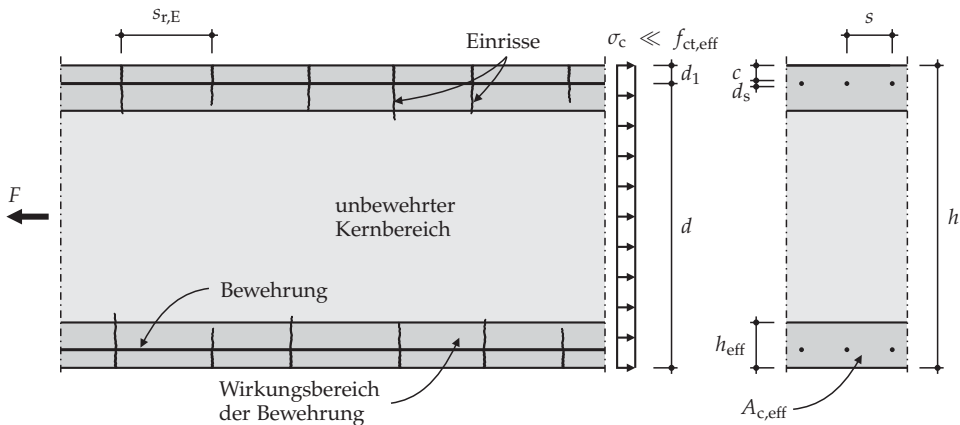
Massiges Stahlbetonbauteil unter zentraler Zugbeanspruchung mit nach der Abkühlung überdrückten Einrissen (Vorschädigung infolge von Eigenspannungen)
